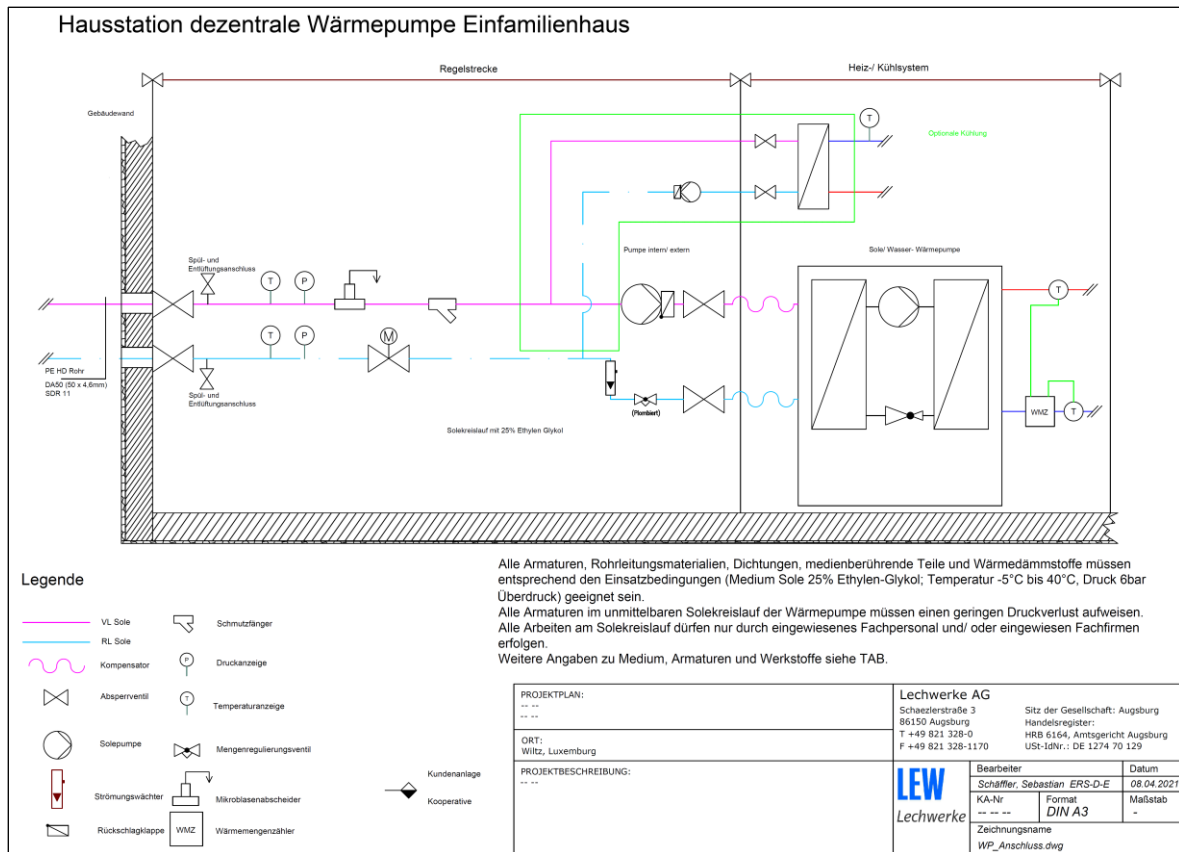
Anschlussschema Hausstation. Quelle: LEW, 2021
